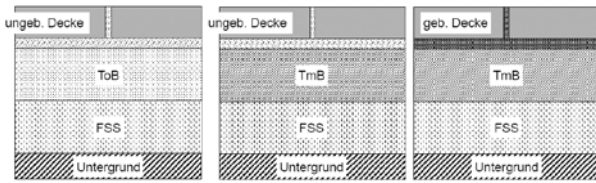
Klassische Oberbaukonstruktionen im Straßenbau mit ungebundener und gebundener Ausführung der Pflasterdecke [5]
